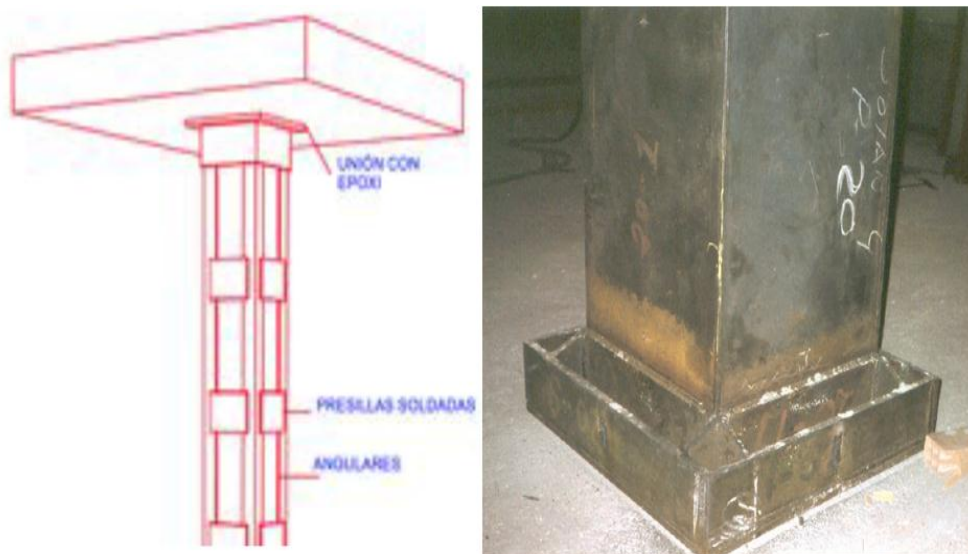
Detalle de refuerzo de pilar mediante angulares en las esquinas y empresillados (De la Rosa Lamata, 2012)
